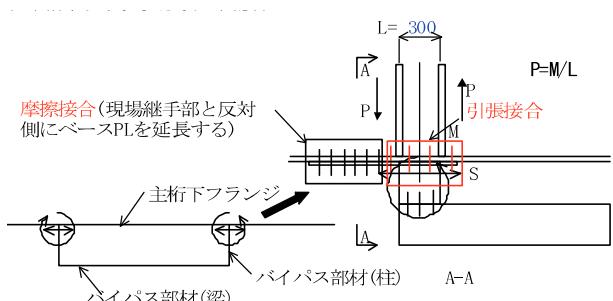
既設主桁-バイパス桁ボルト接合部の設計概要
